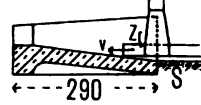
Führung des Vorderzapfens an Wehren der Oder.
